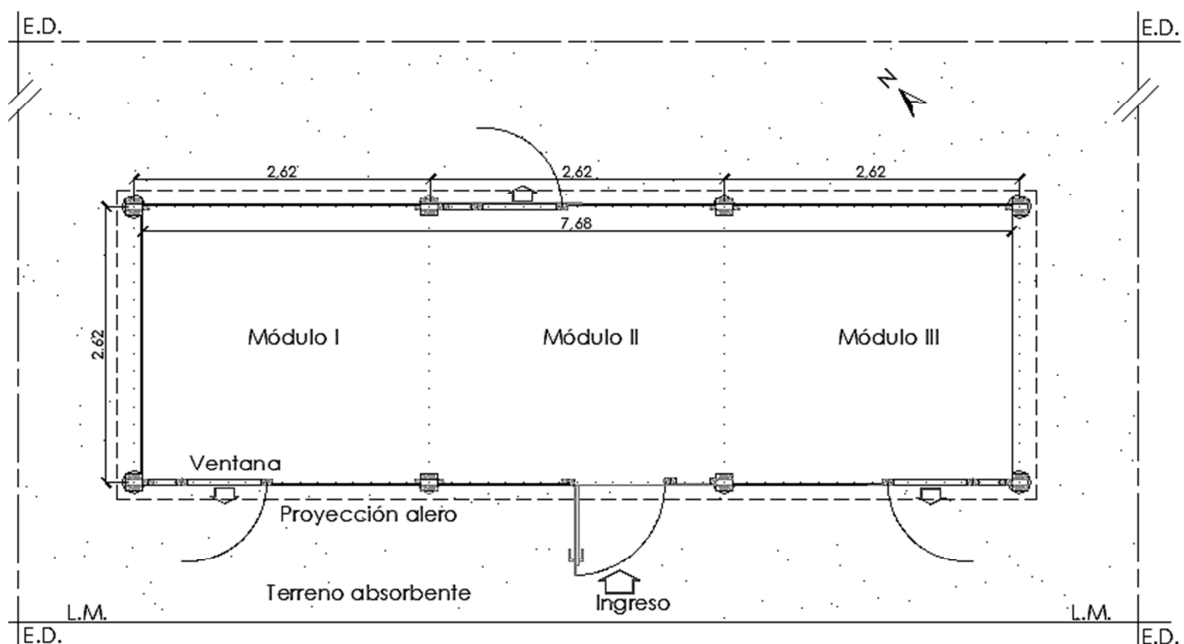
Plano de la vivienda tipo. Elaboración propia.
